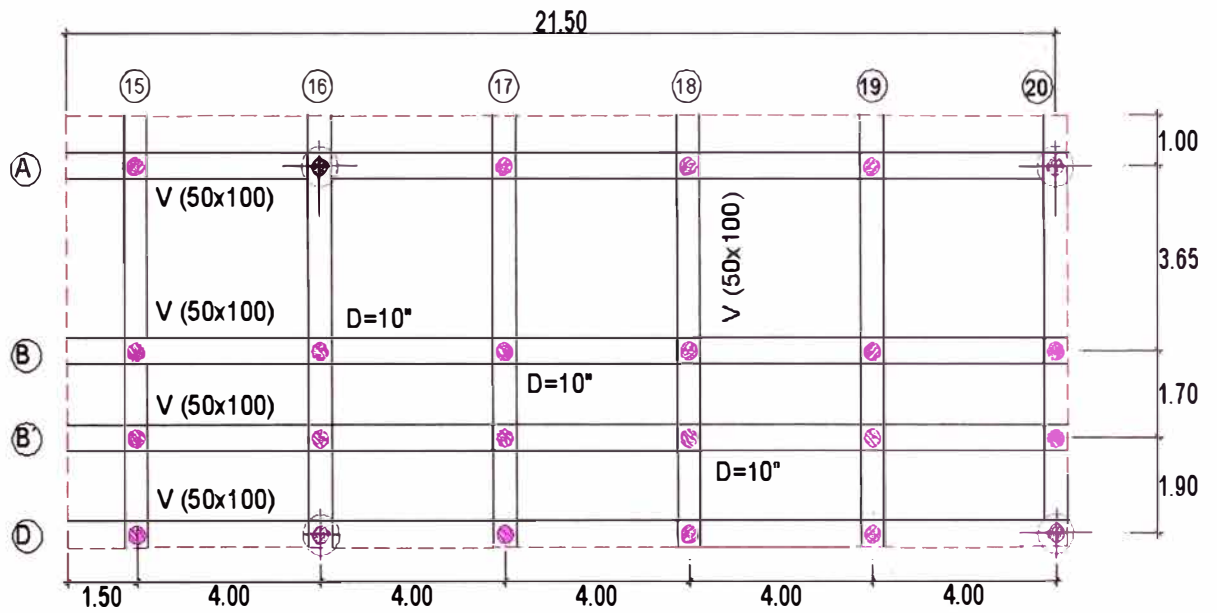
Distribución de vigas superiores en el 3er tramo
